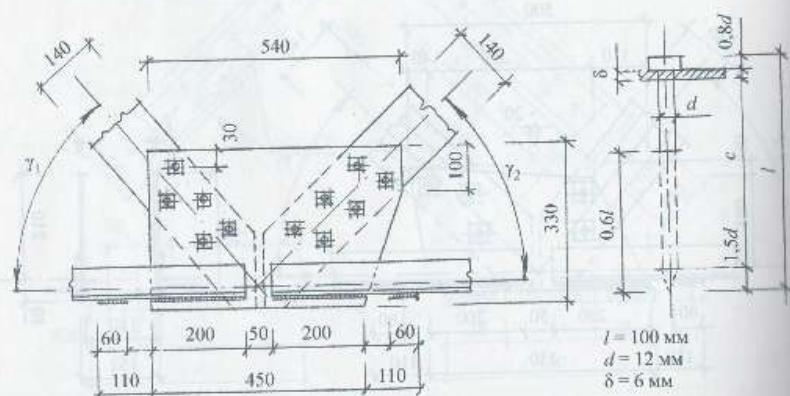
Промежуточный узел нижнего пояса фермы. Вариант 2
